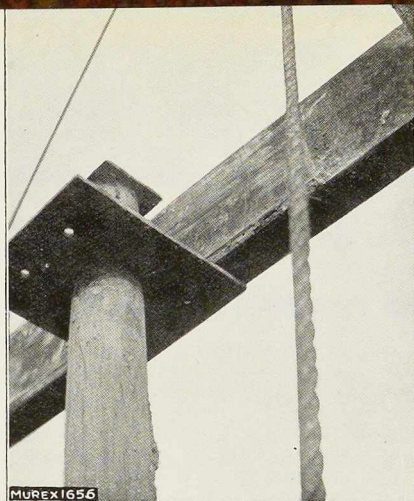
Vue prise avant l'exécution des soudures sur place, de l'assemblage d'une colonne tubulaire.
